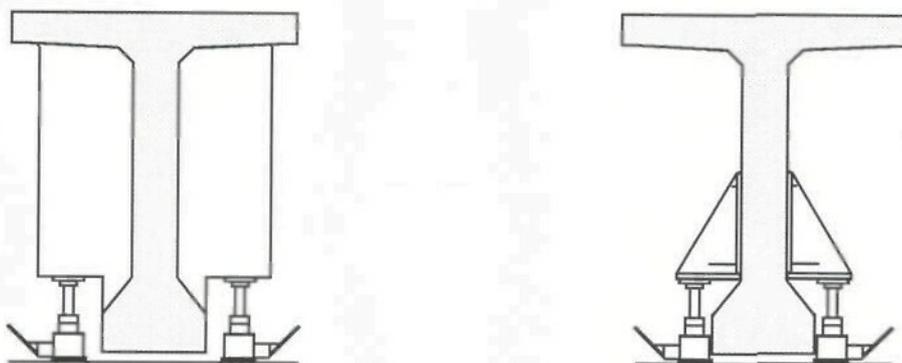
Soulèvement des poutres par amorces ou fausses amorces
